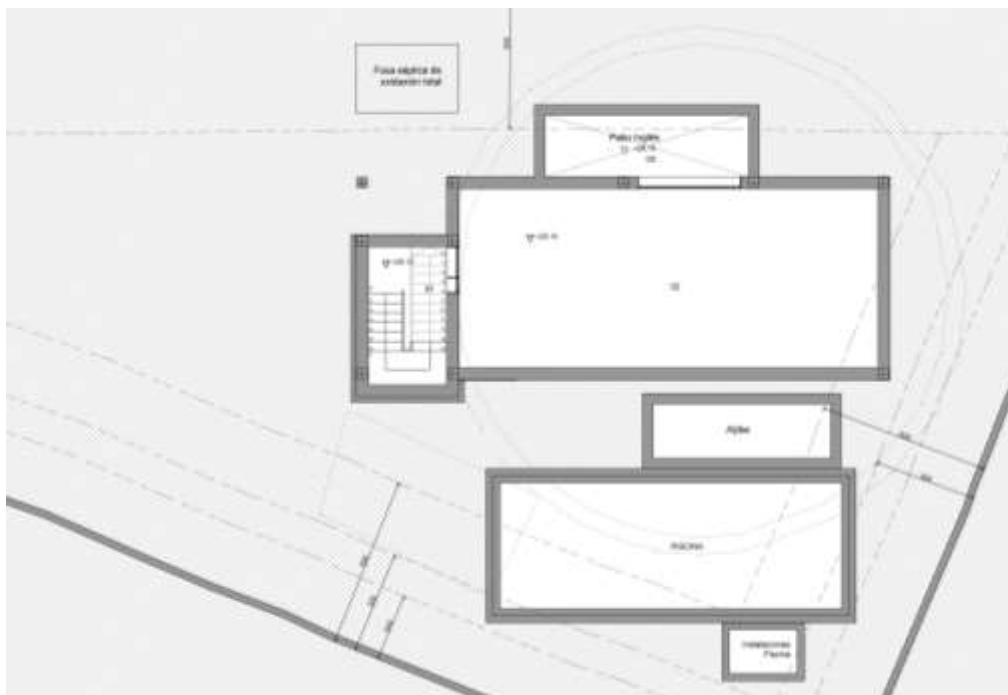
Planta sótano. Fuente: Proyecto básico y de ejecución.
